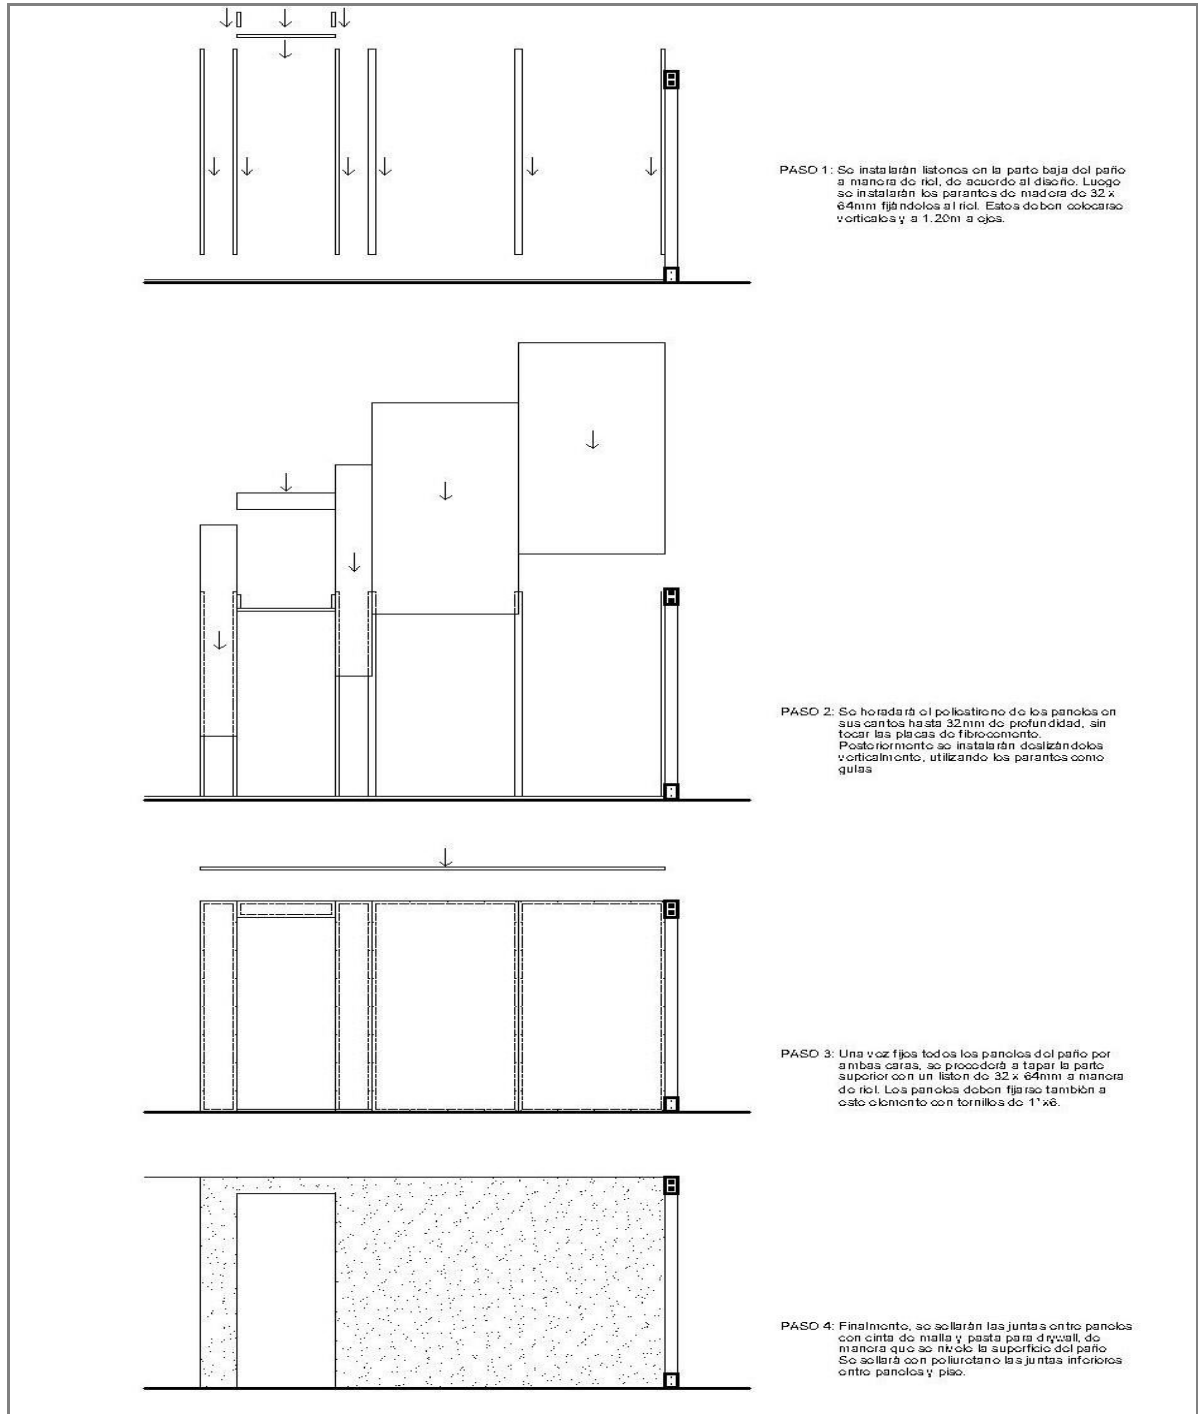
Descripción de montaje panel TECNOPLACA – Método 2
